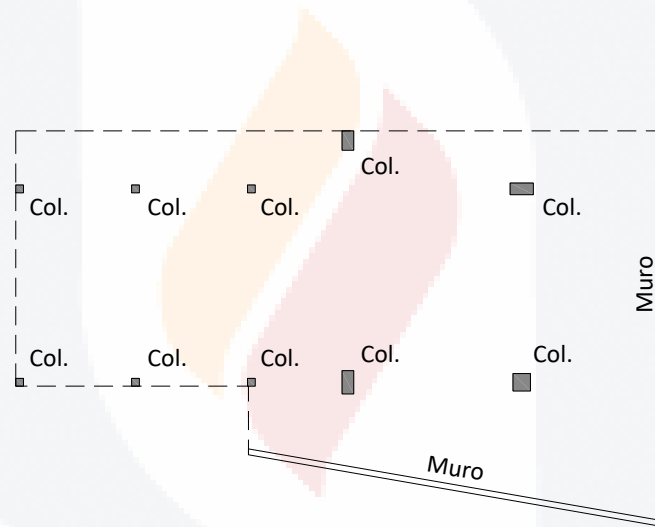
Planta del sembrado de columnas en anexo de edificio de gobernación de Quindío, Colombia.
